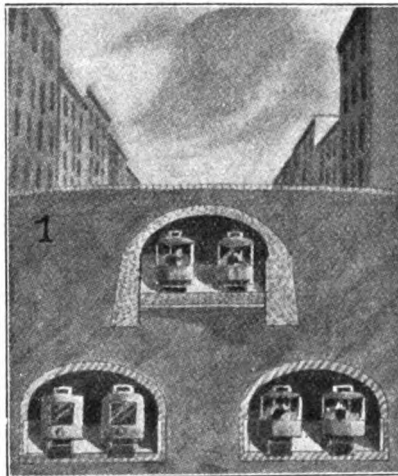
Tunnelstrecke unterhalb der Park Avenue.
